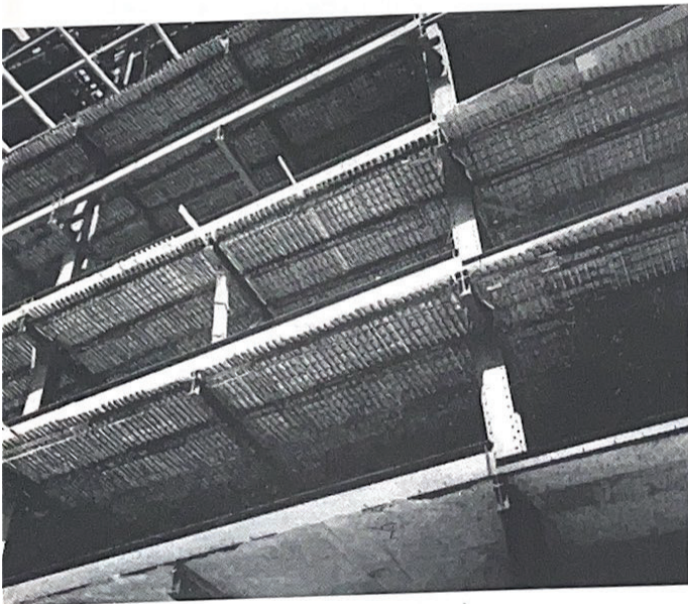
Vista parcial das esteiras sôbre Longarinas.
